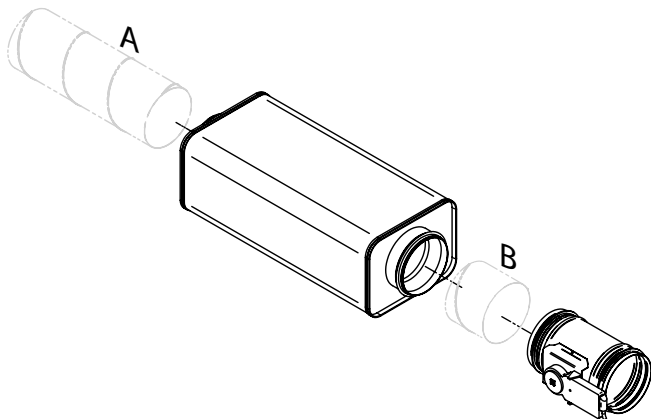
Kit d'air introduit, PARAGON T-SAK-VAV-125
